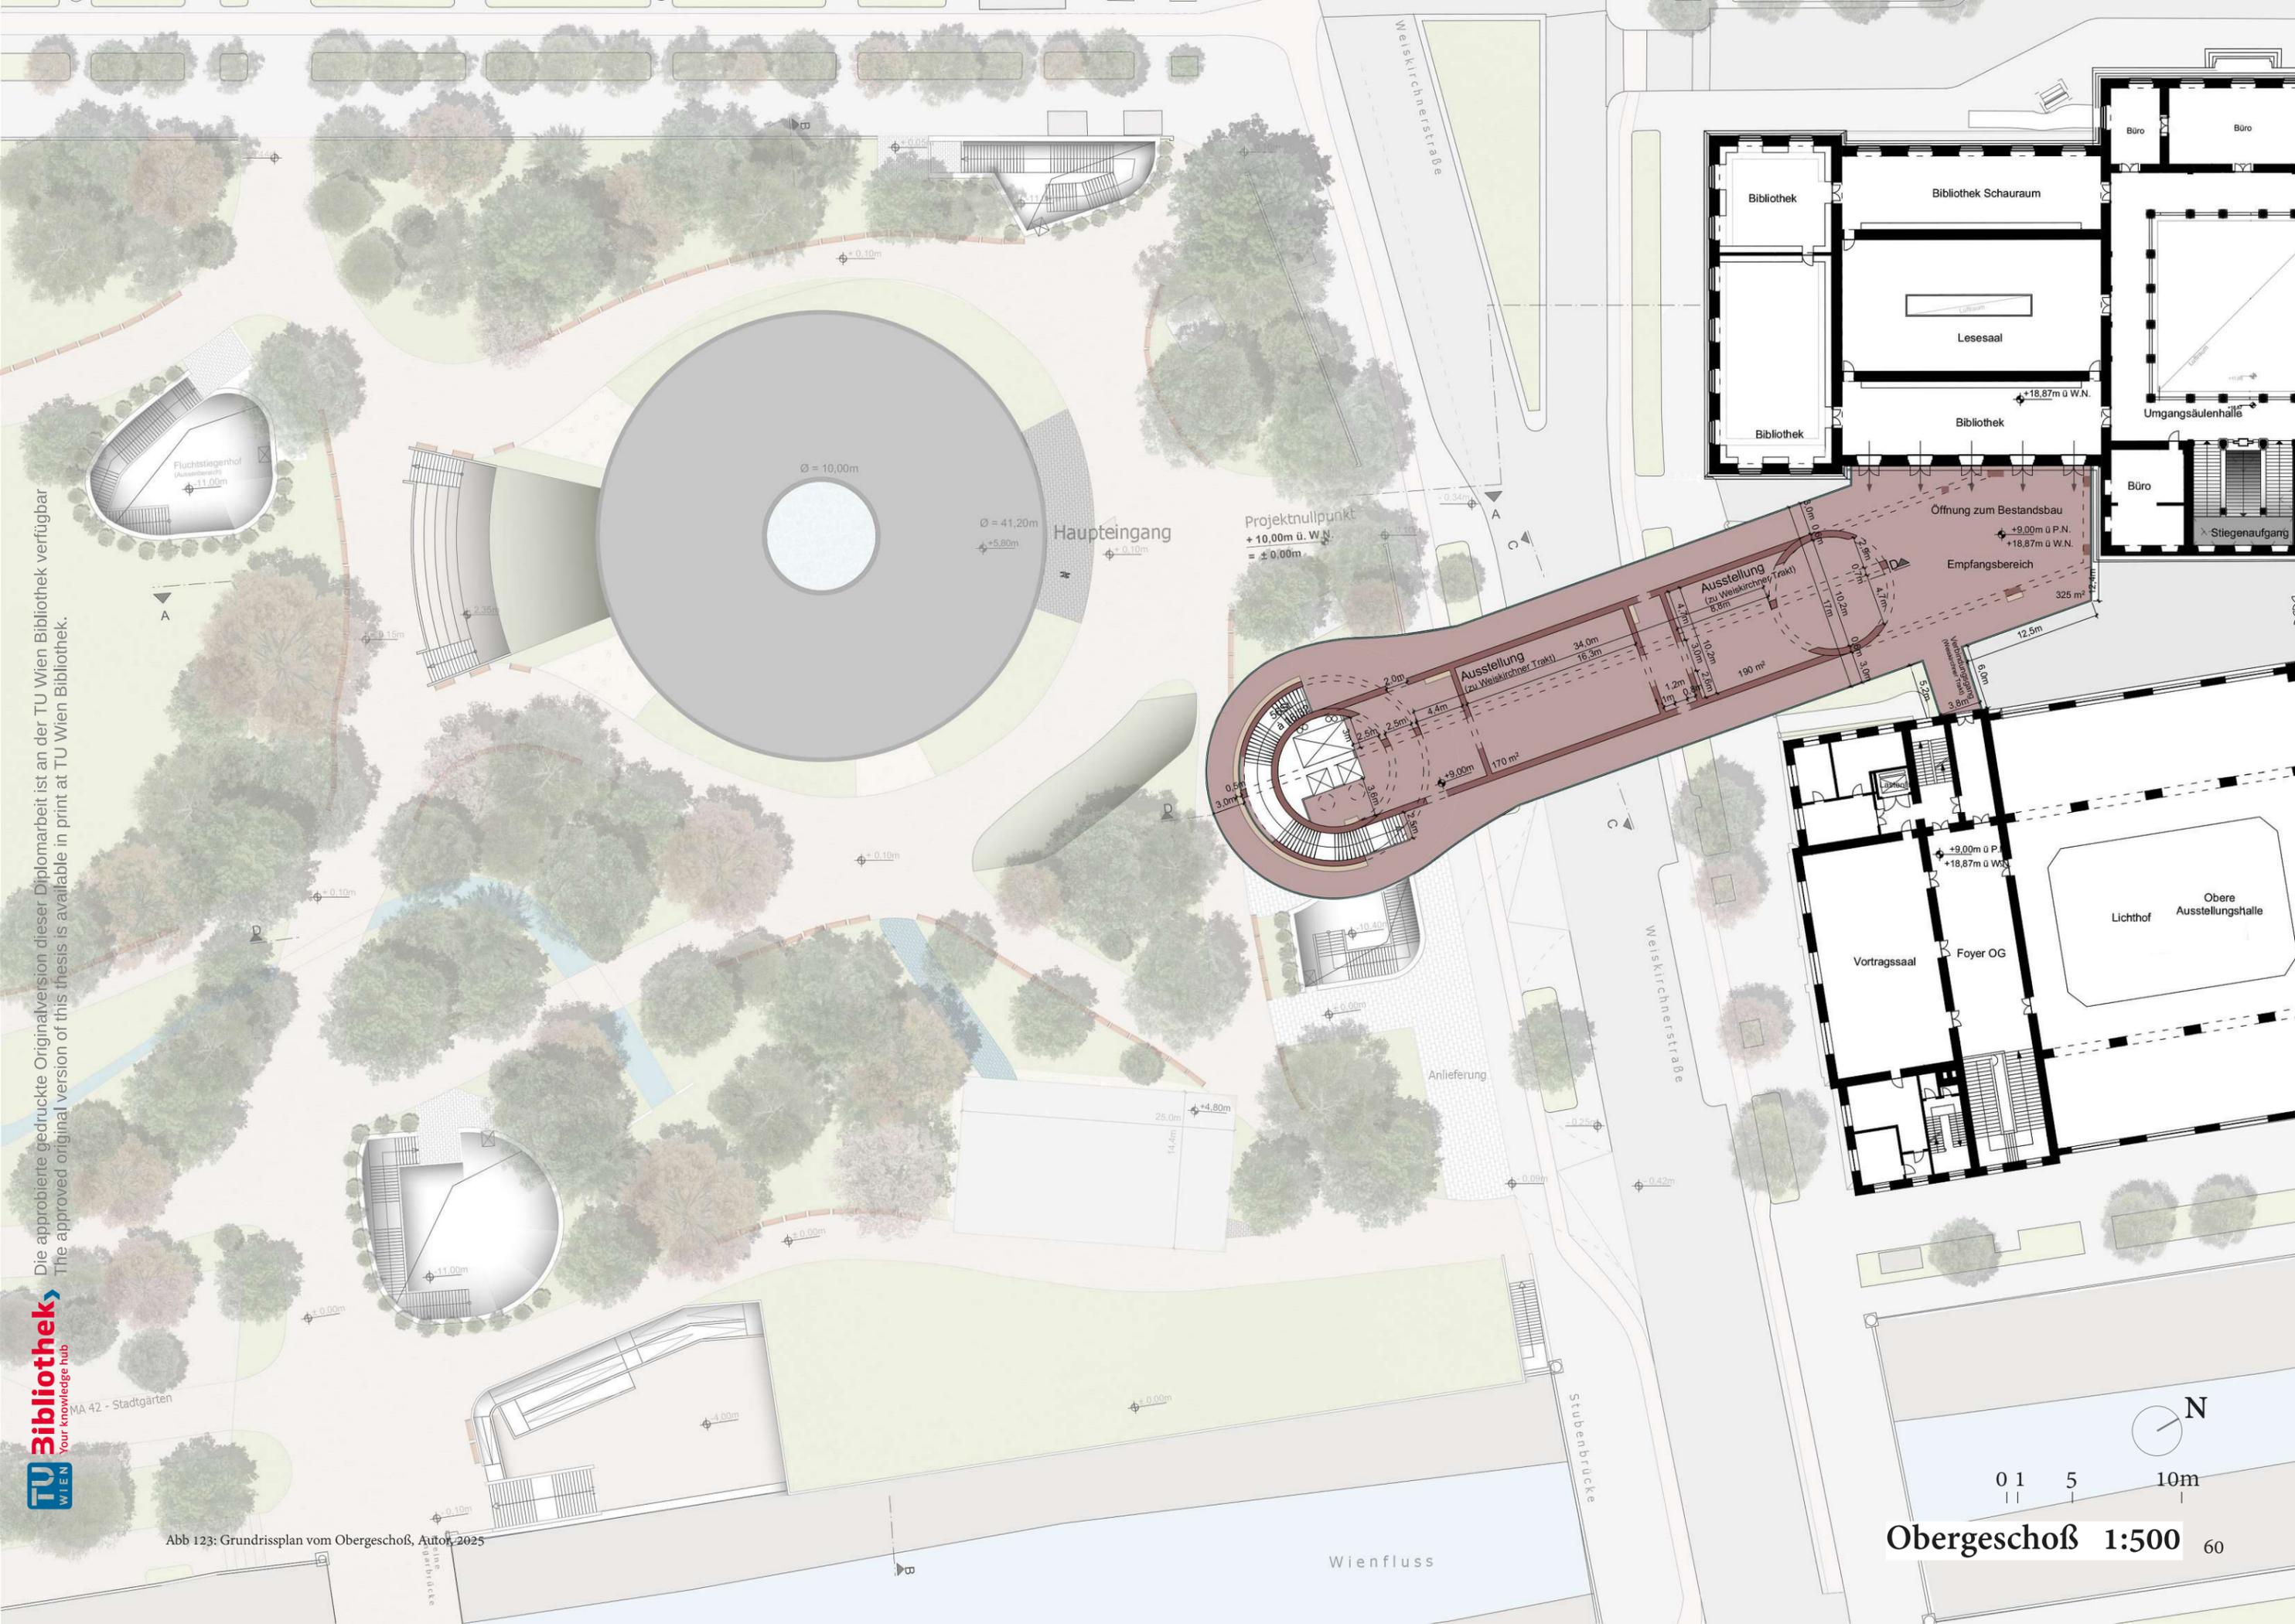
Grundrissplan vom Obergeschoß, Autor, 2025
